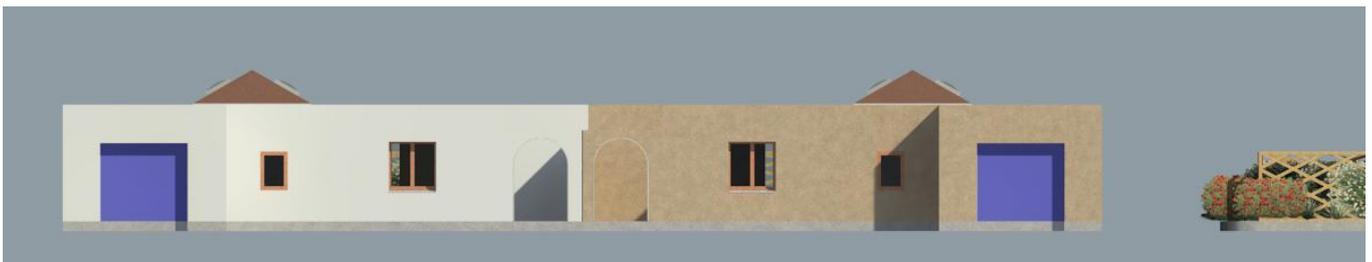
Façade avant d'un pâté de maisons HID jumelées. Source : Auteur 2017.
